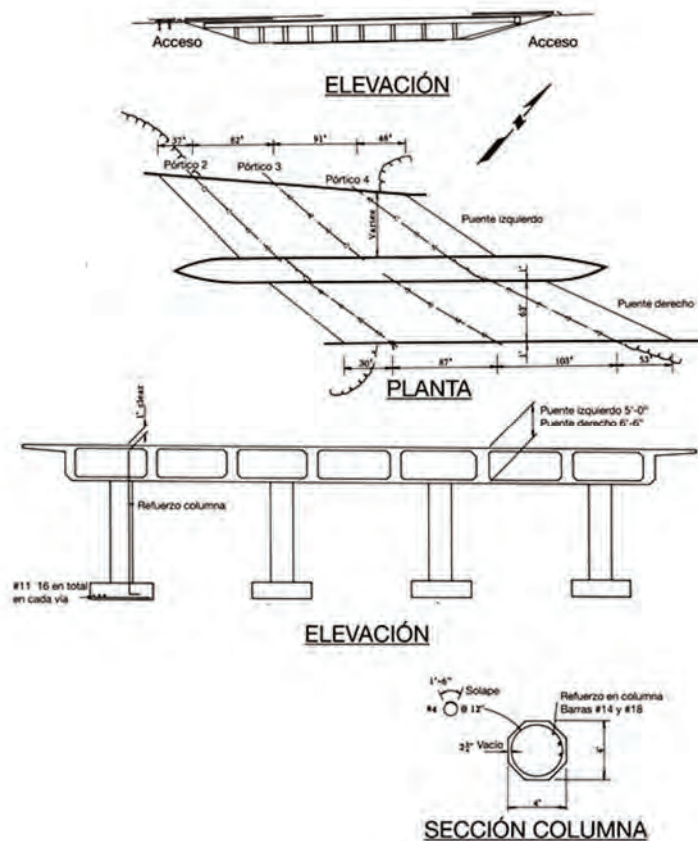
Planta, elevación y detalles constructivos del puente en esviaje Foothill Boulevard Undercrossing. (Fuente: Benfer et al., 1973, p. 228)
